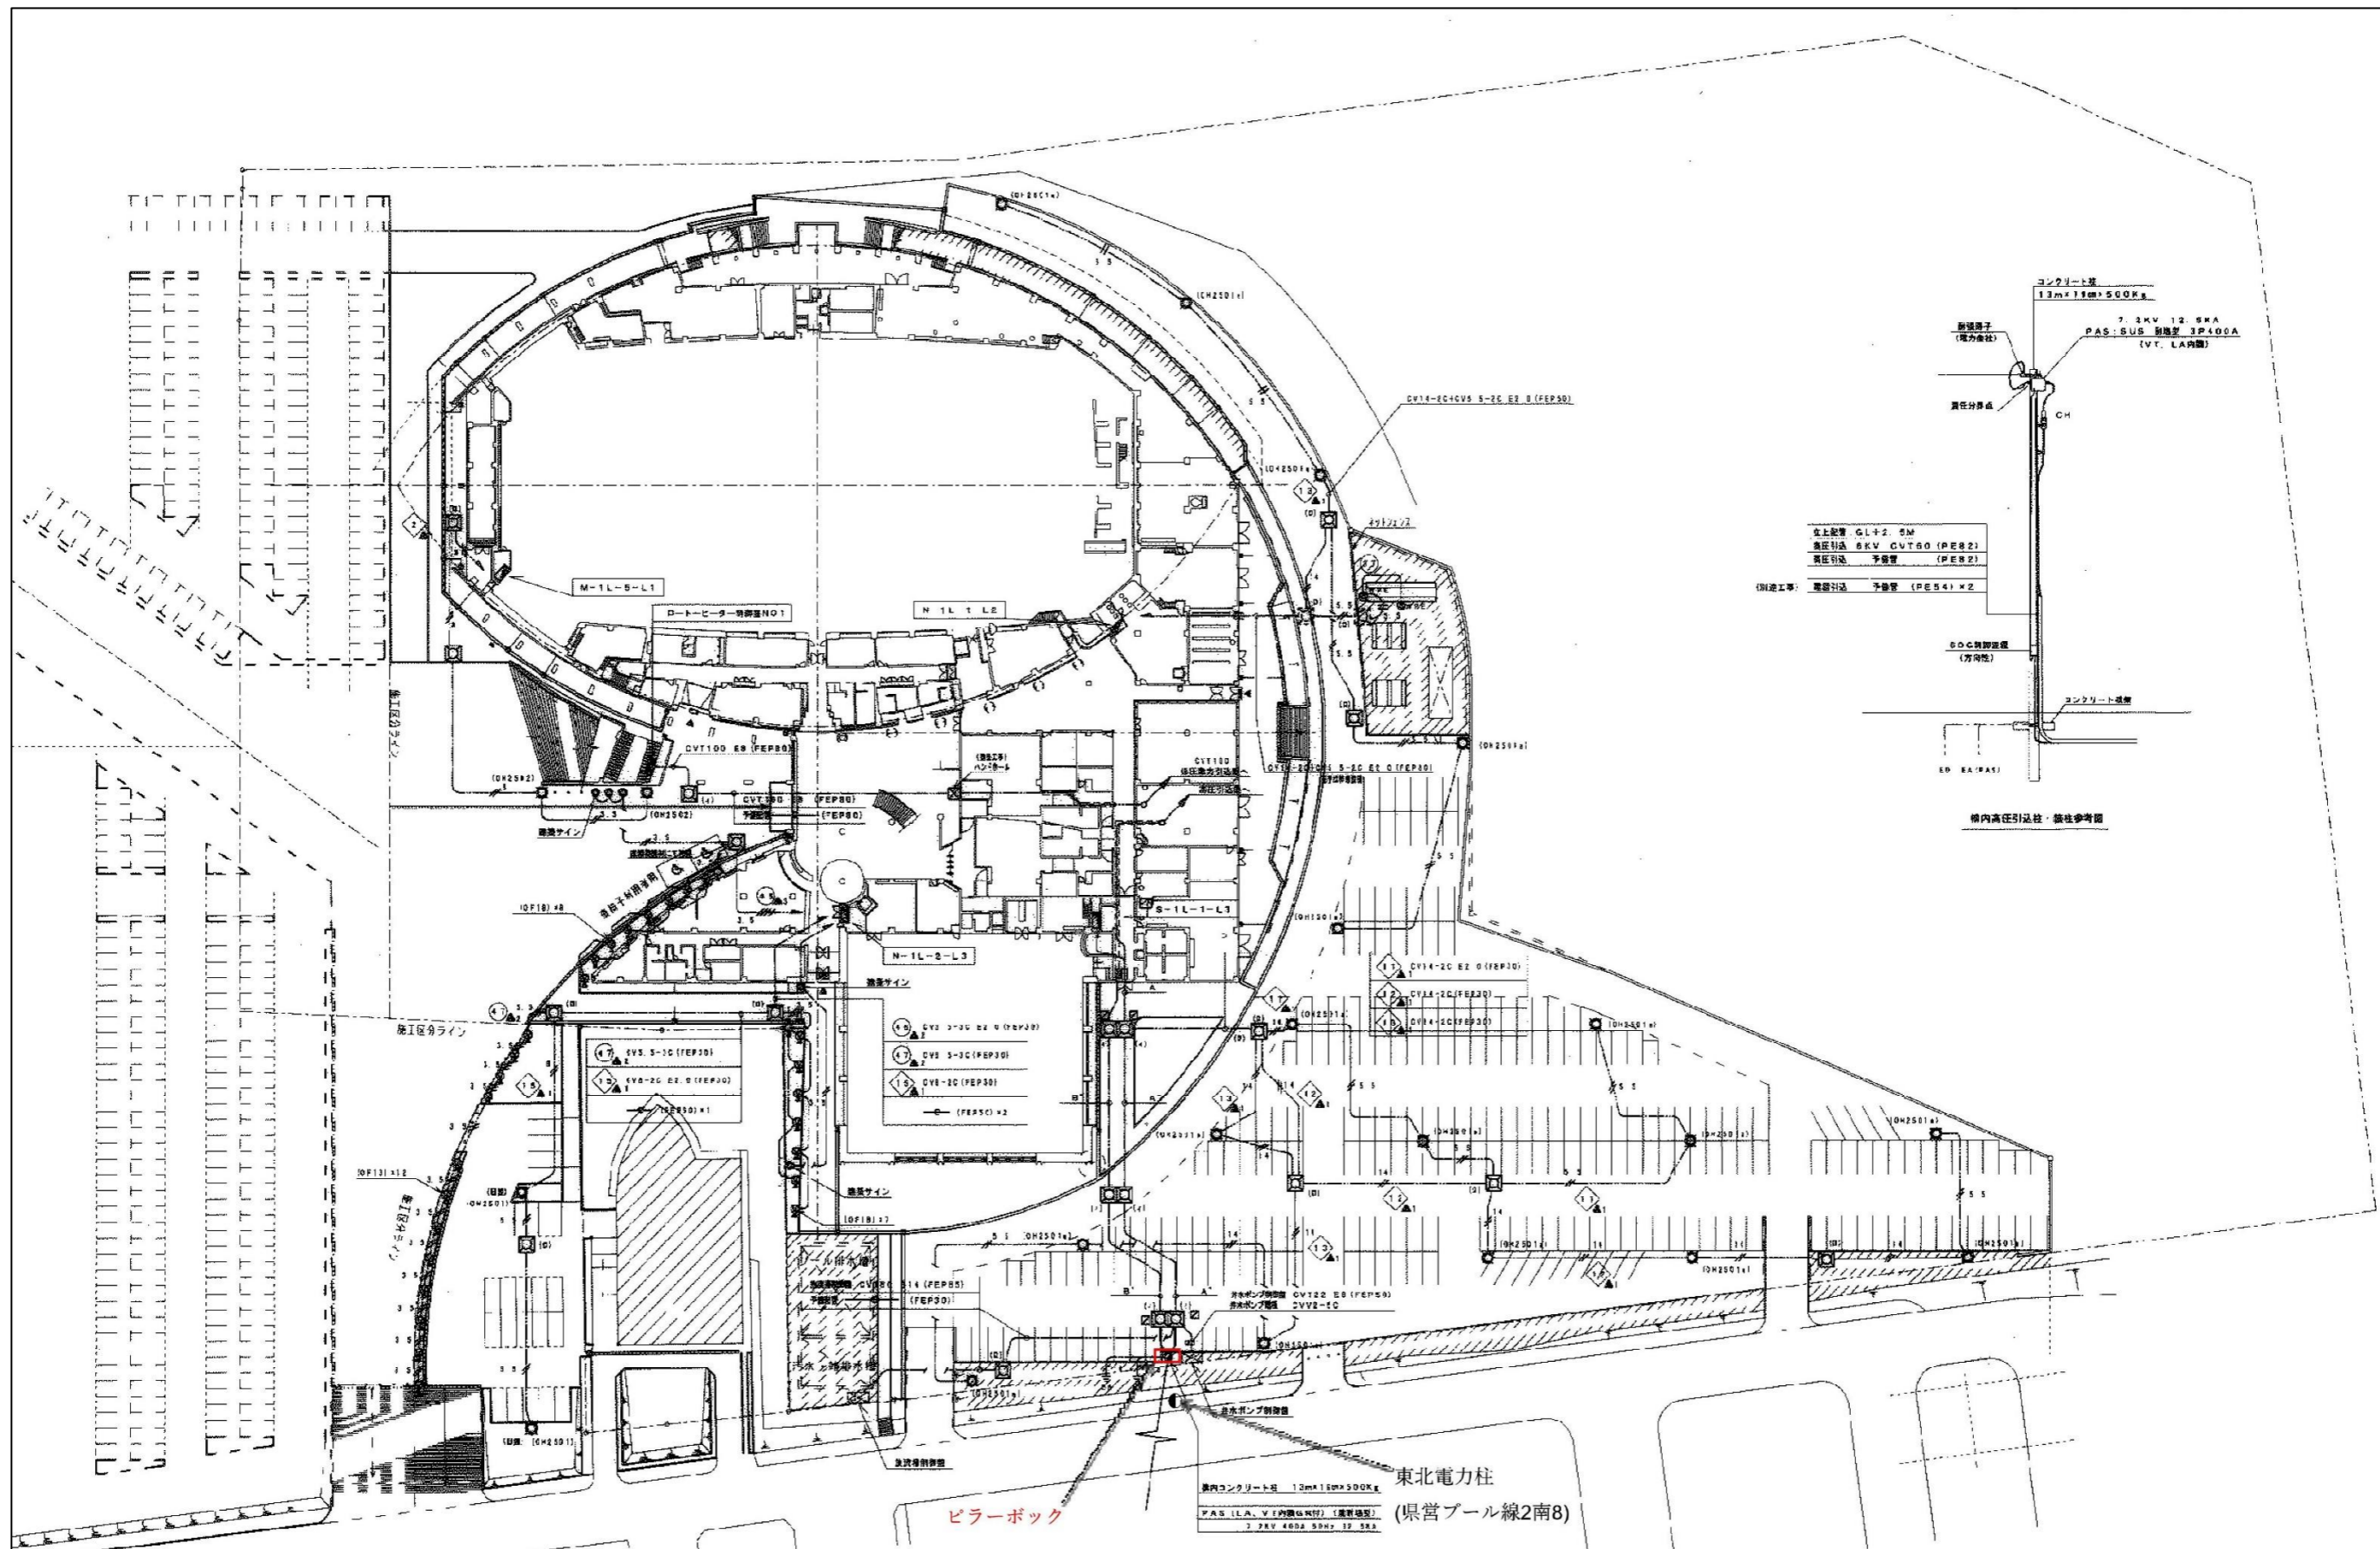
県立総合プール平面図 (ピラーボックス設置位置案)
